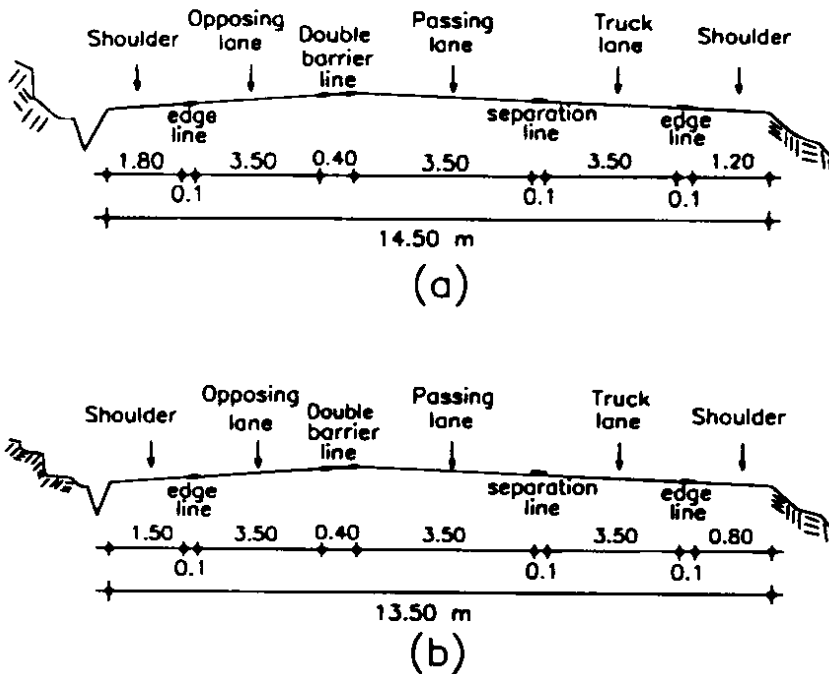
Secciones Transversales Recomendadas: (a) 14,5 metros de Ancho y (b) 13,5 m de Ancho, Mendoza y Mayoral (1996).
